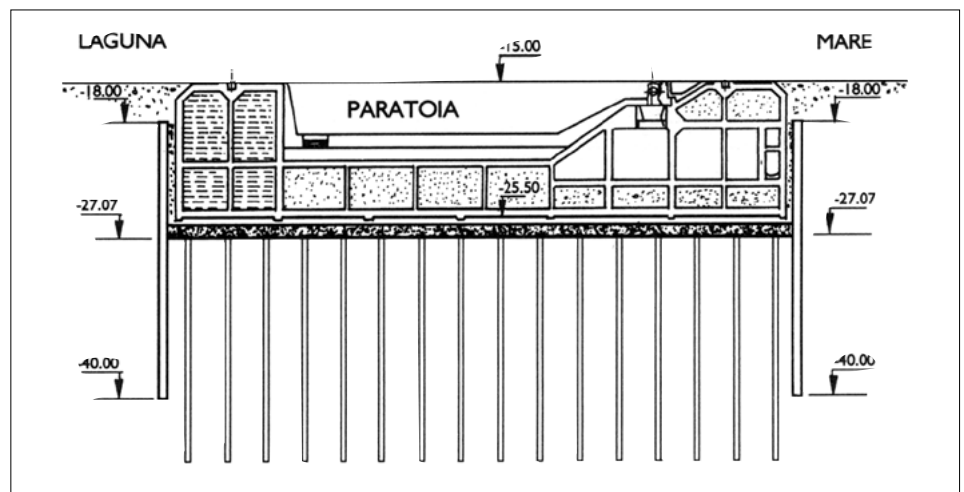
Opere mobili alle bocche di porto. Sezione tipo della struttura di fondazione delle paratoie
